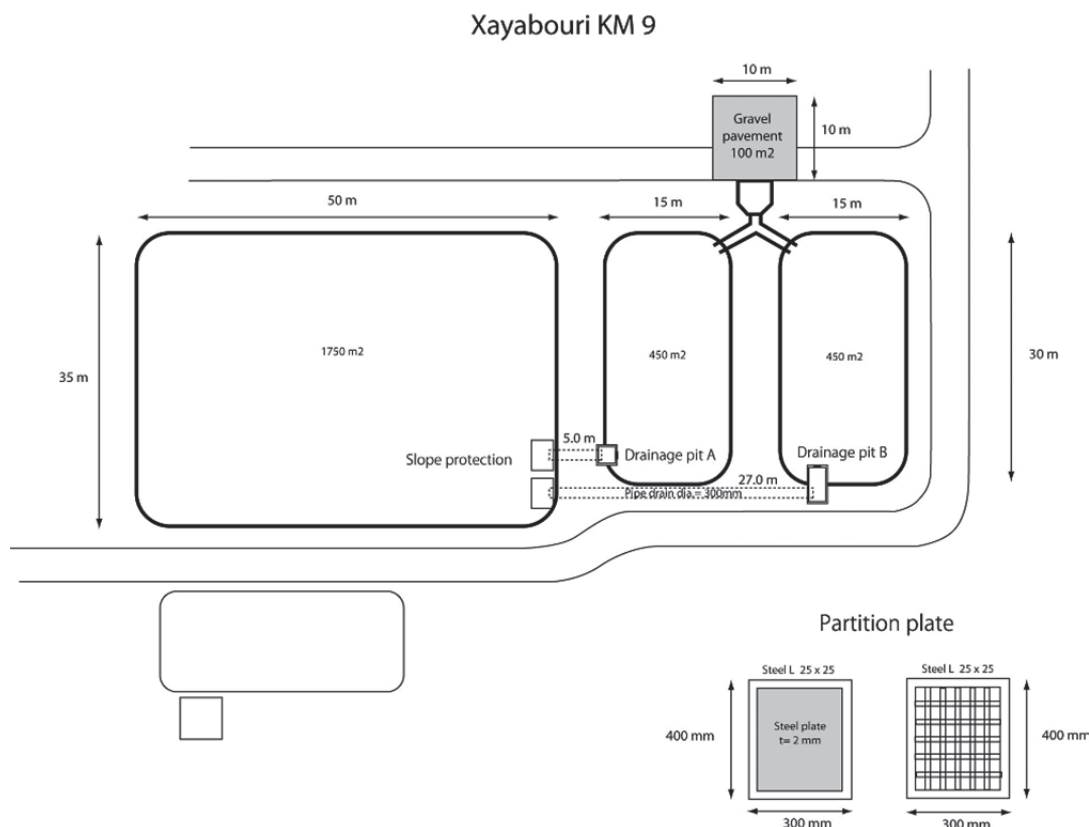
し尿浄化槽汚泥の処理施設の平面図
